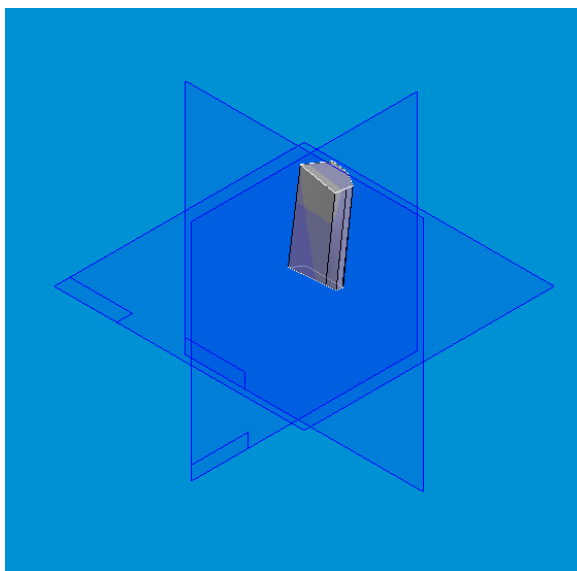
Ricostruzione geometrica del pilastro 20.
